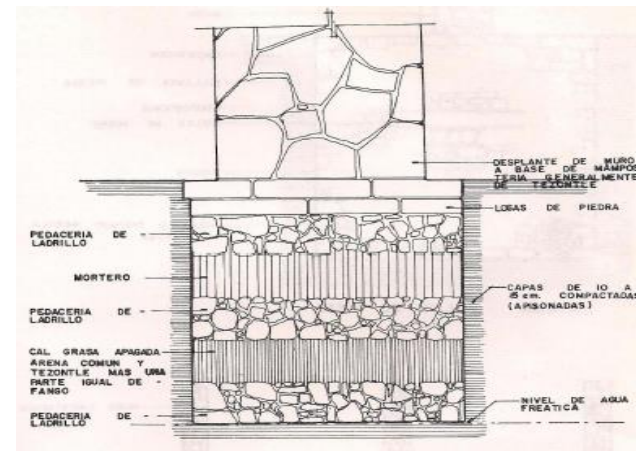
Detalle de Cimiento con aplicación de cal grasa apagada.
